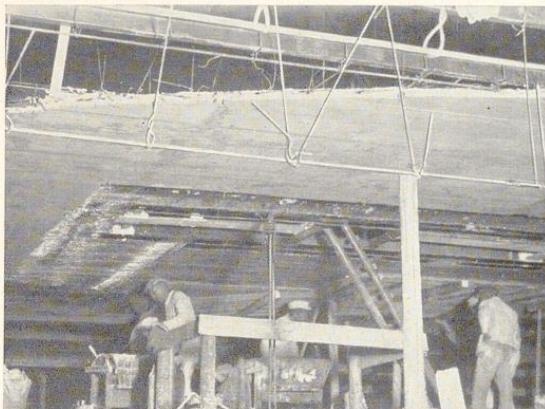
Gußrabitzdecke mit einer Aussparung zur Ausführung der Gießarbeit
